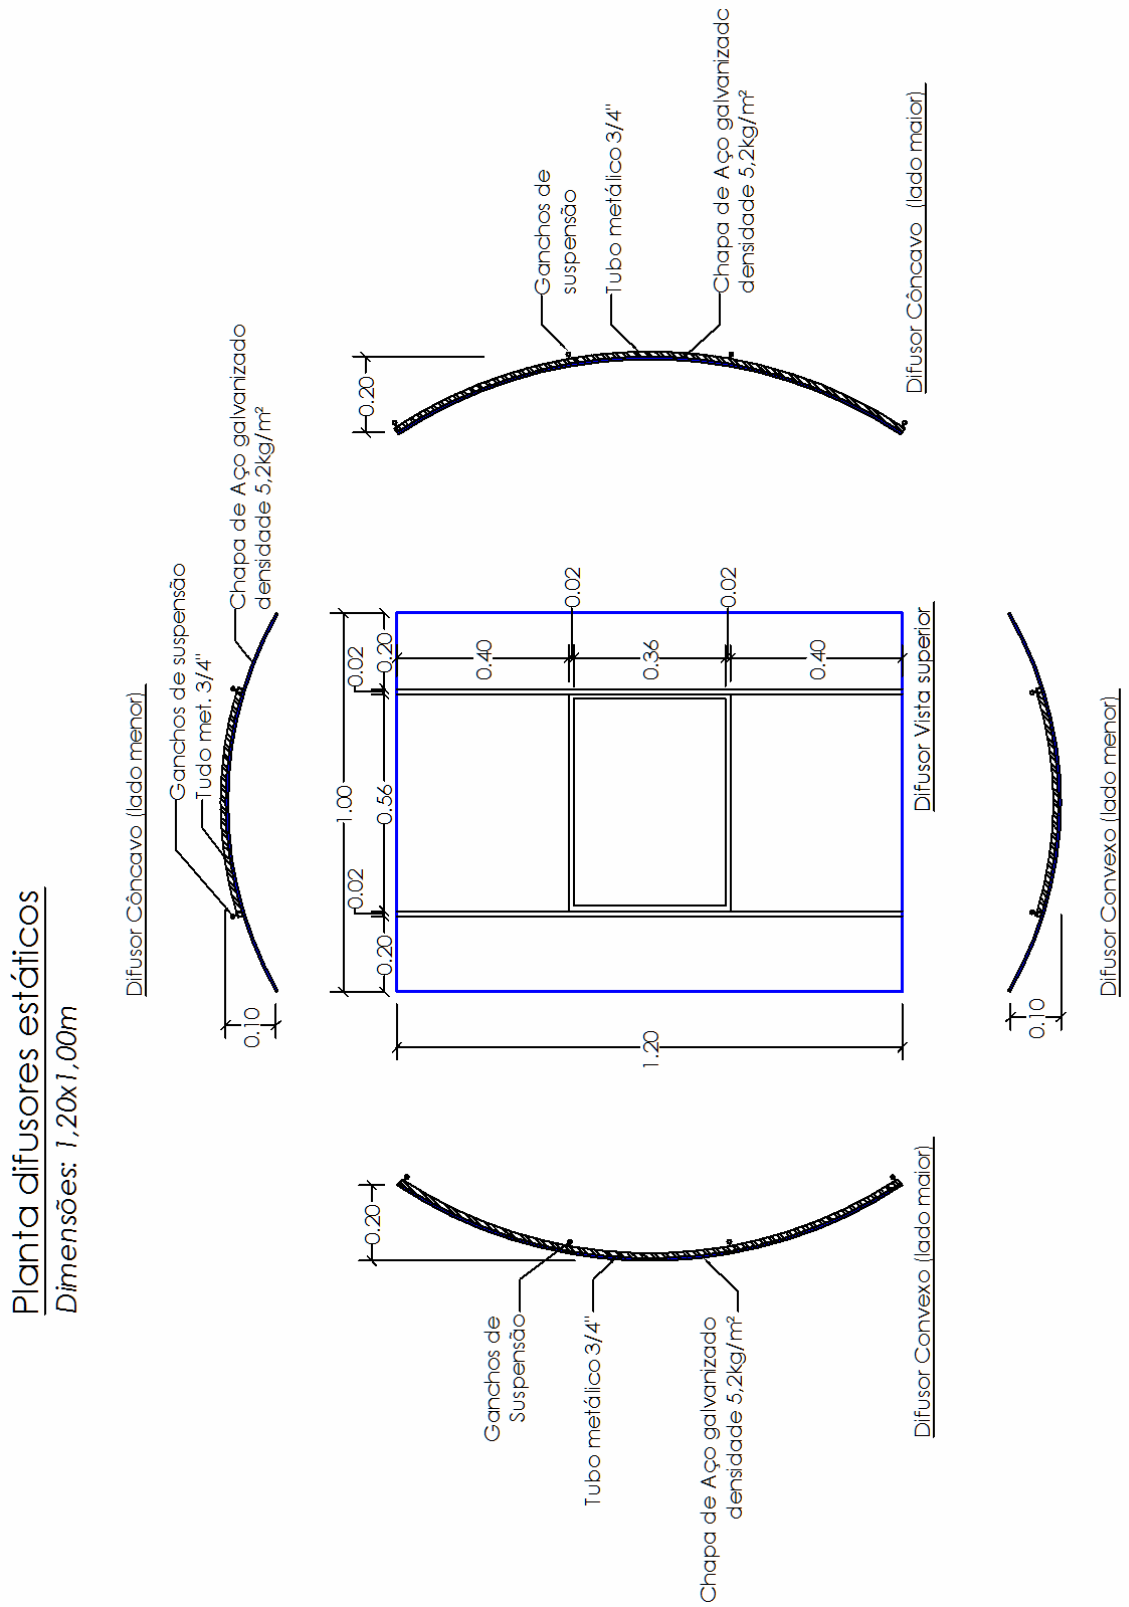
Planta esquemática dos difusores estáticos nas dimensões 1,40 x 1,00m (medidas em metros)
